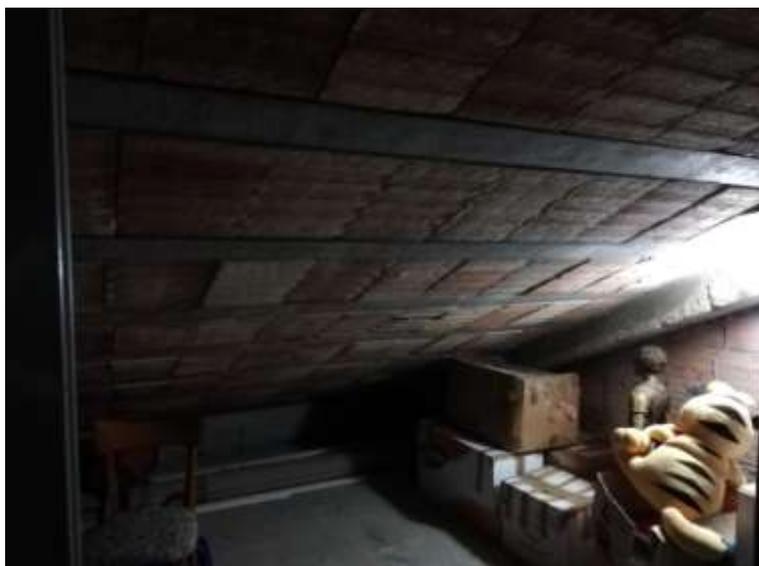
Locale cantina d rifinire e sanare una porzione di ampliamento che occupa il corridoio.
